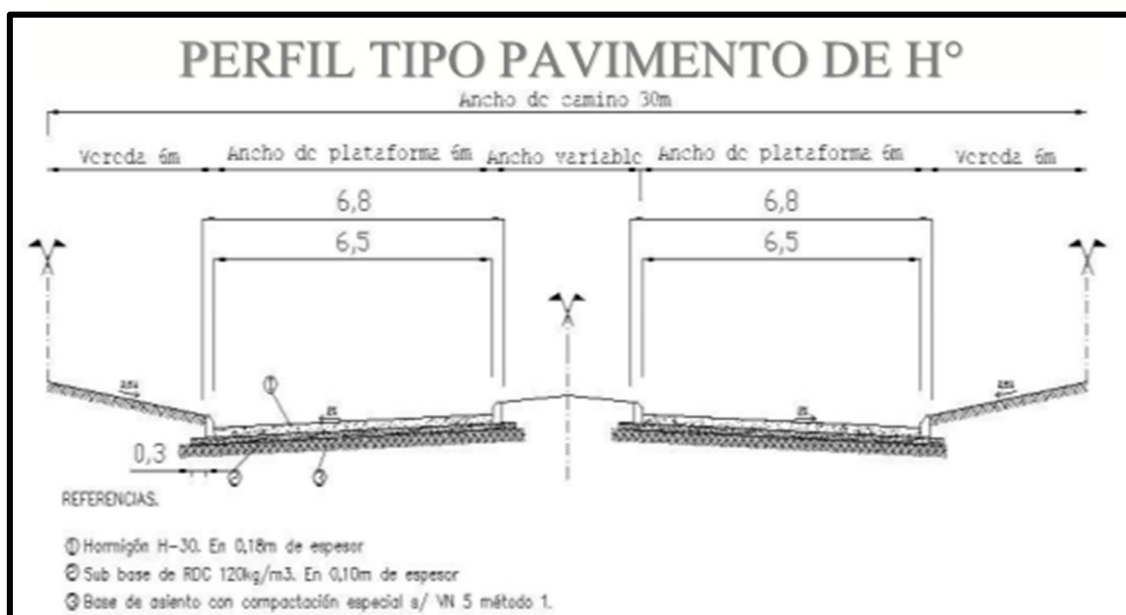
Perfil tipo de avenidas de pavimento de hormigón (fuente: DVP).
